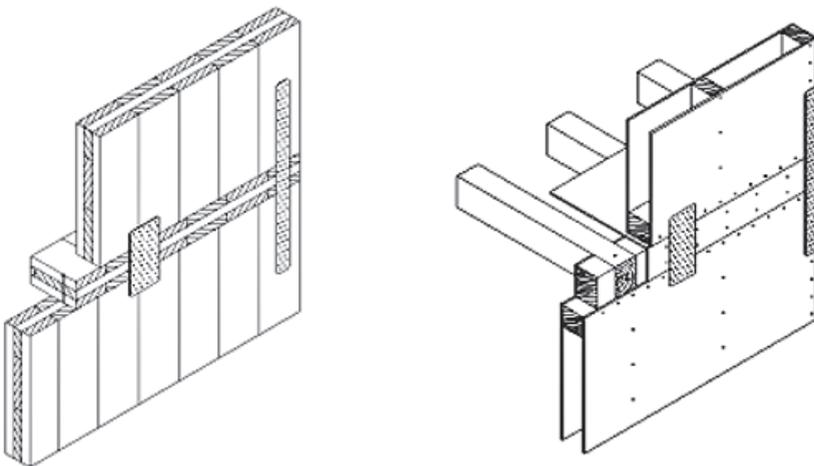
Appoggio della parete sul solaio di interpiano: collegamento a trazione mediante nastri forati, collegamento a taglio tra parete superiore e parete inferiore mediante piastre forate, collegamento a taglio tra solaio e parete inferiore mediante viti, rispettivamente per pannelli XLAM e intelaiati
